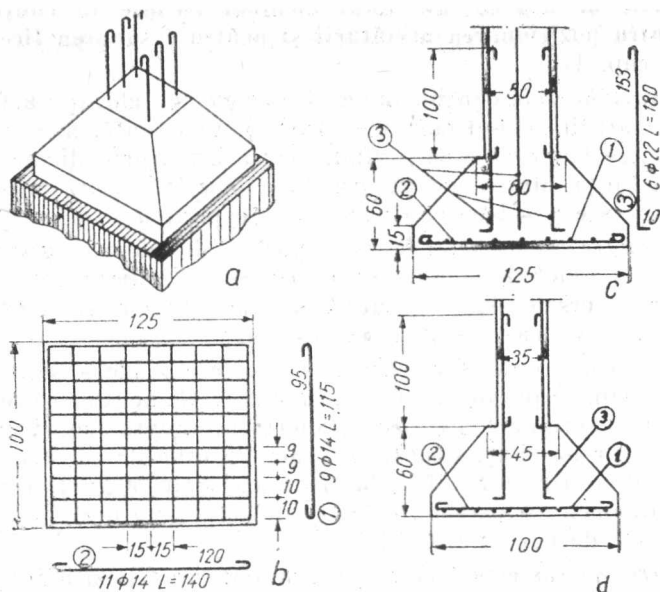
Cuzinet din beton armat, vedere în perspectivă și planuri de armare.
